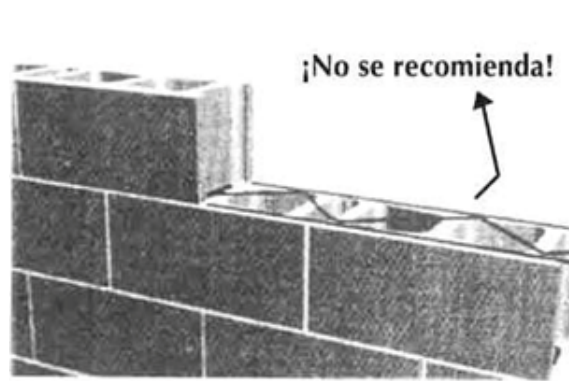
Escalerilla con travesaño en diagonal (Bravo, 2007)
